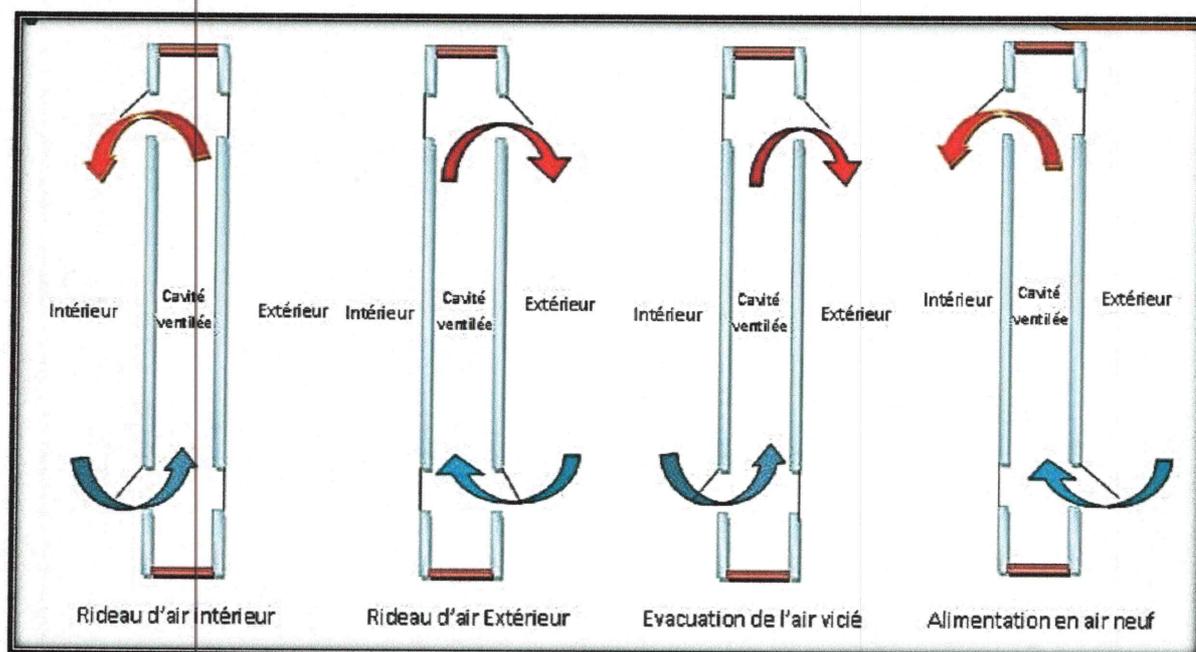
Schéma représente les différentes modes de ventilation de la façade double peau.
